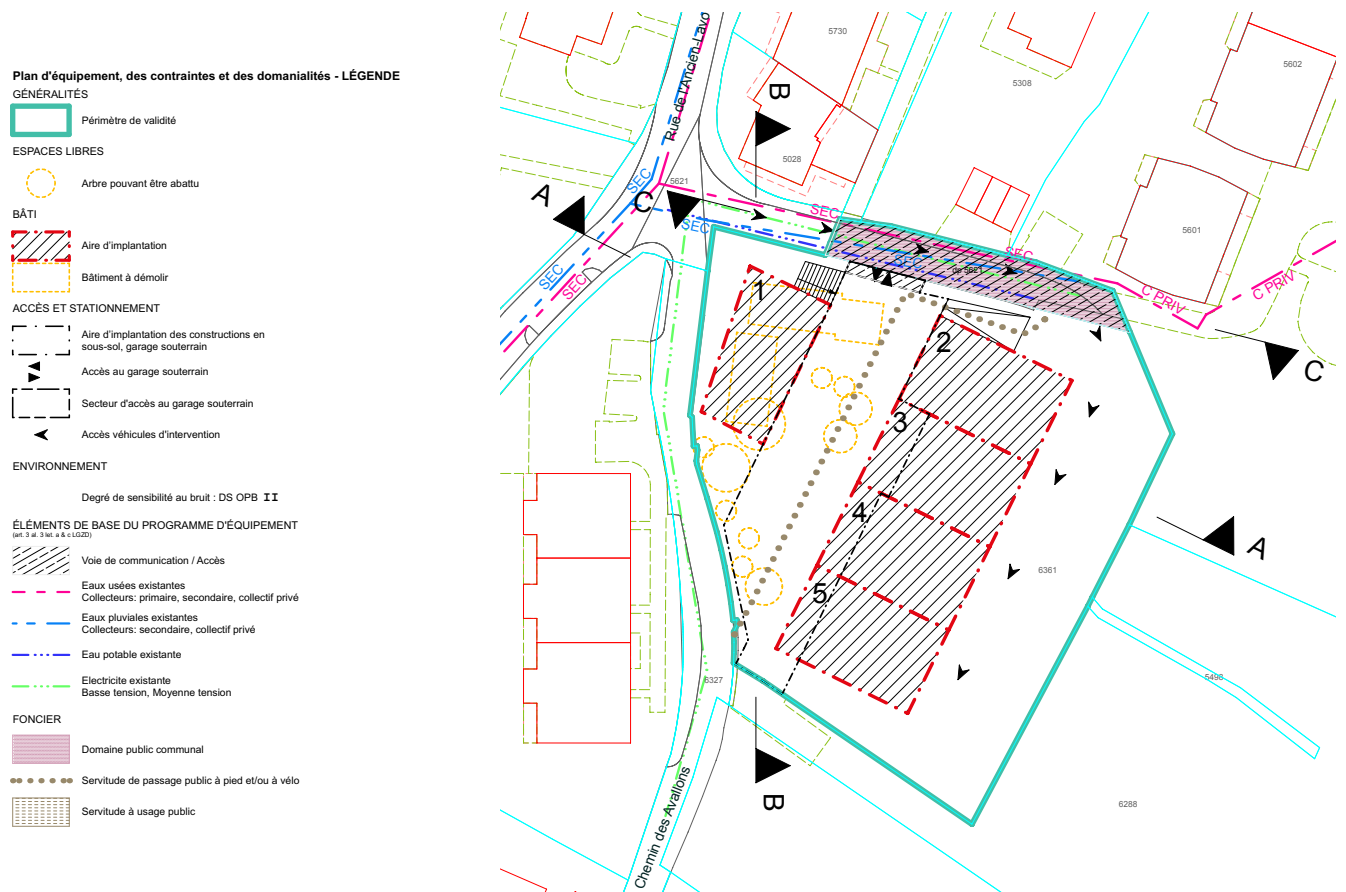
Plan d'aménagement (Avant-projet PLQ du 08.05.2023 – Enquête technique au 1:500)
